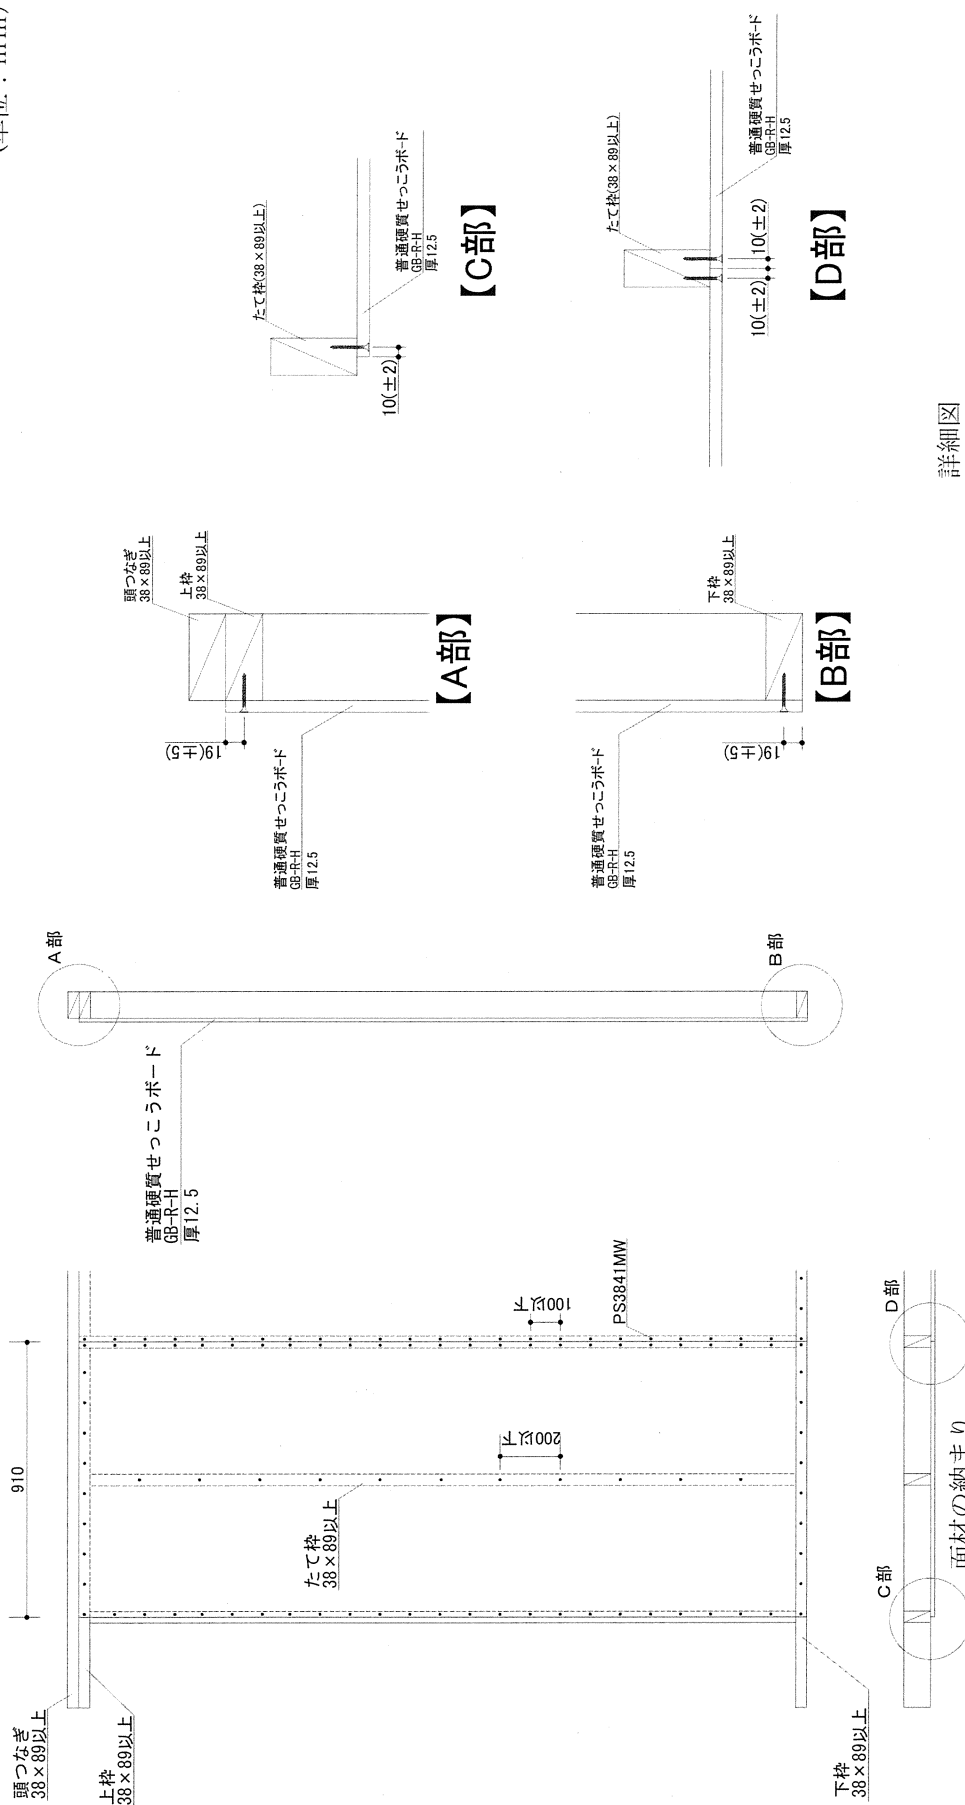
施工図：縦継ぎ張りの場合 (寸法単位：mm)
